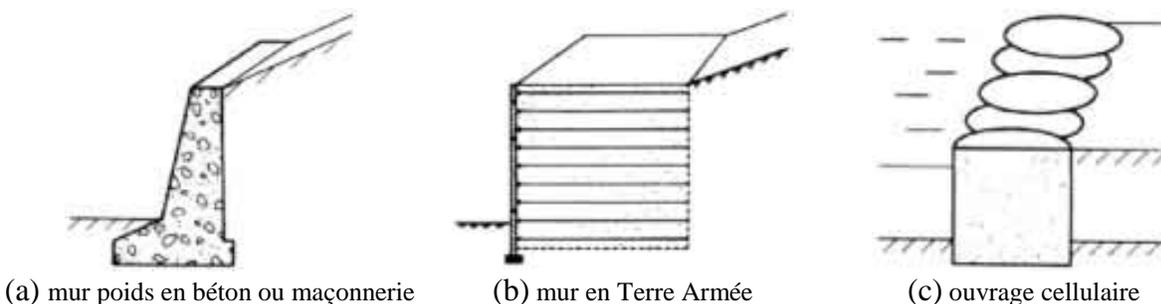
Type d'ouvrages de soutènement - poussée reprise par le poids de l'ouvrage
